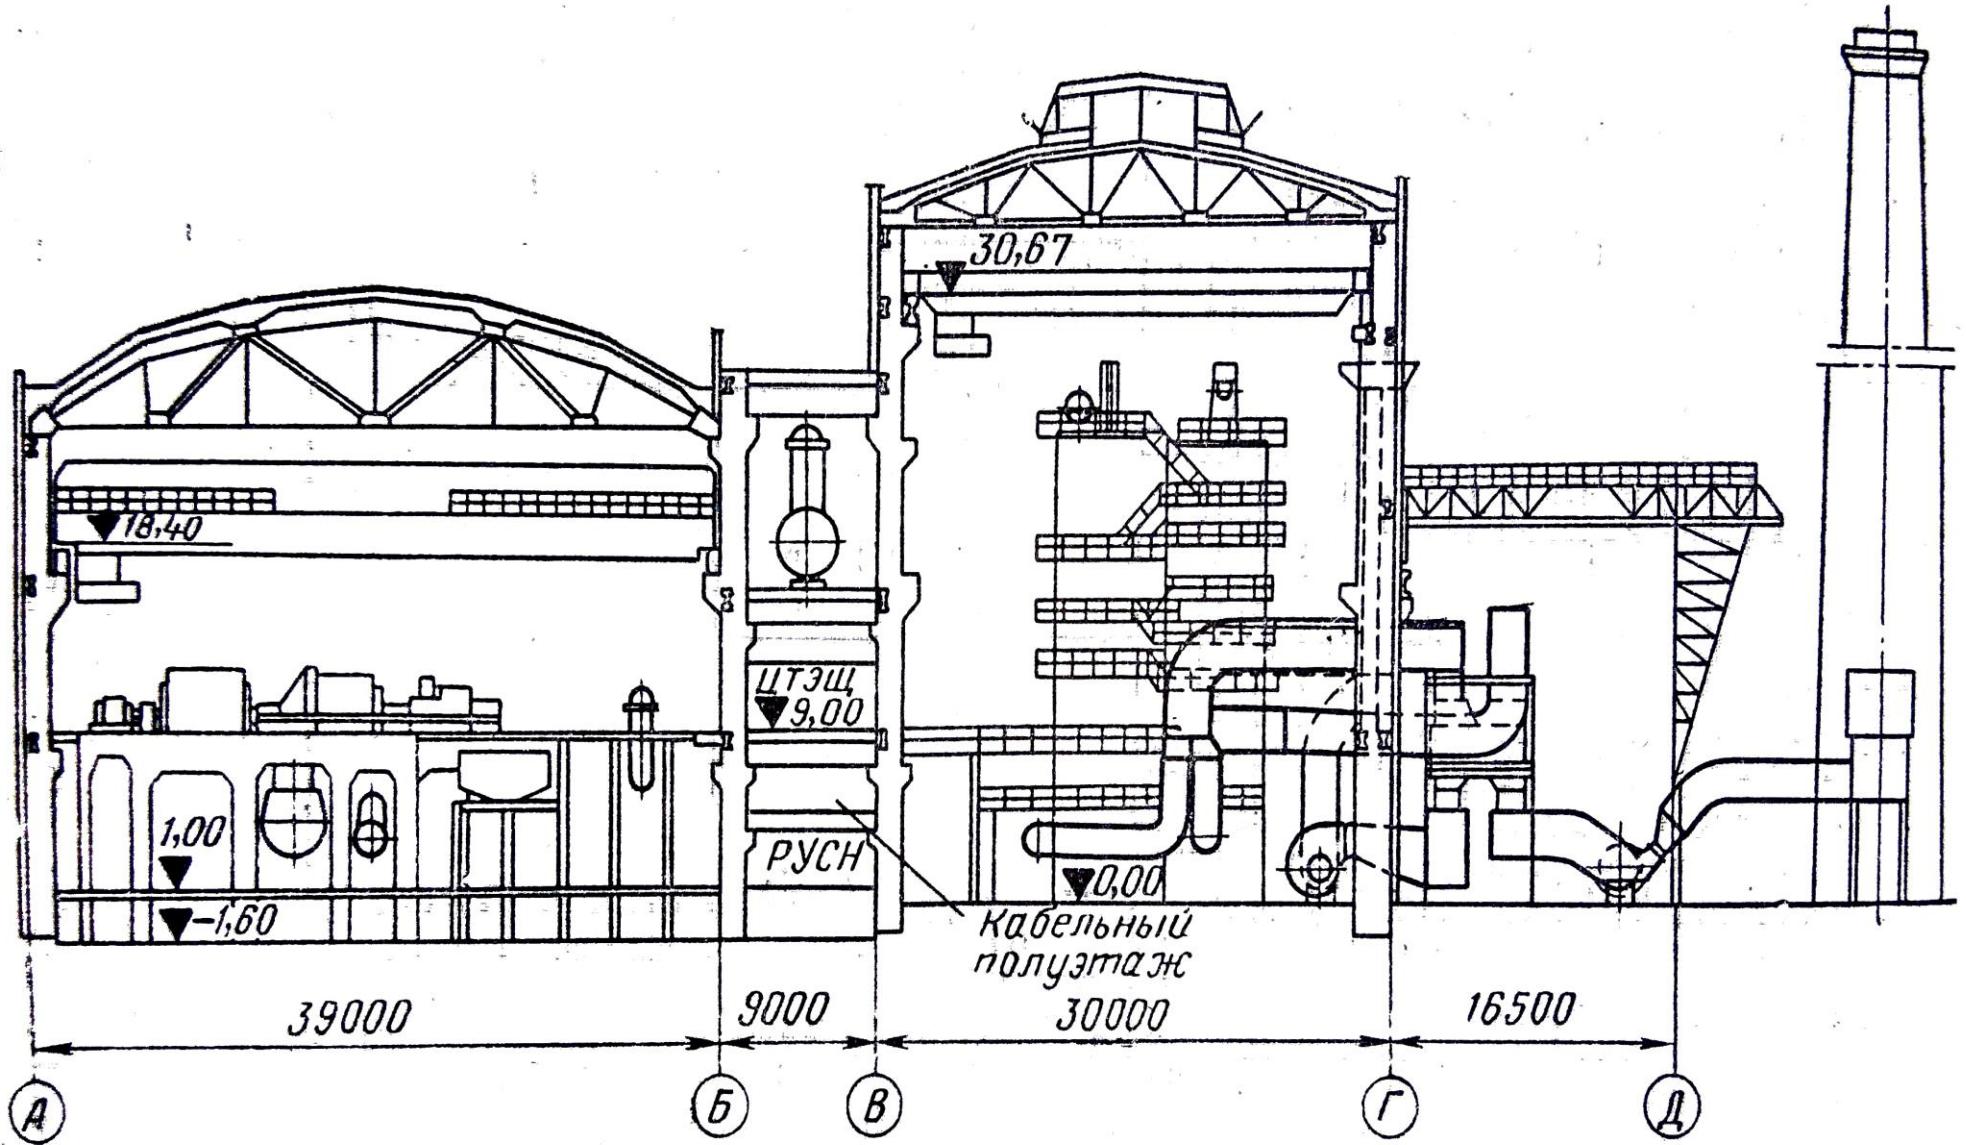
Поперечный разрез по главному корпусу газомазутной ТЭЦ.
